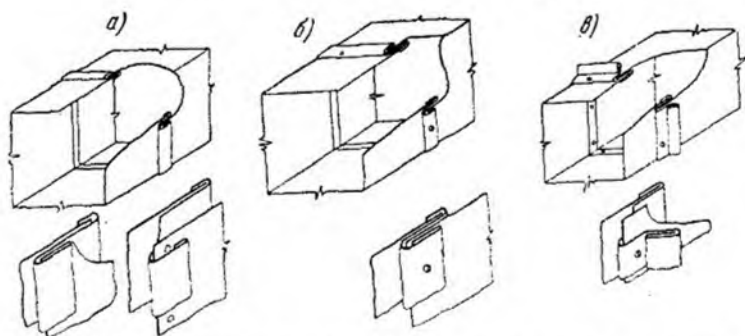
Соединение воздуховодов прямоугольного сечения на планках
